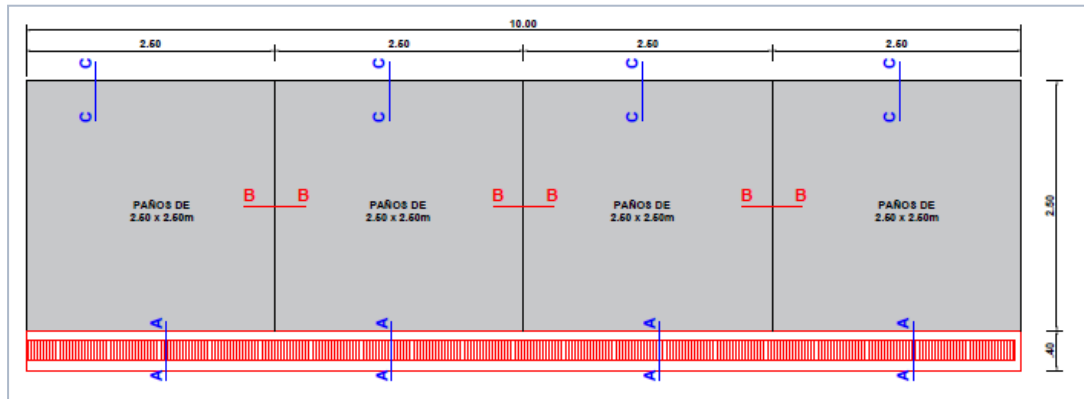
DETALLE DE LOSA DE SECADO PERFIL
